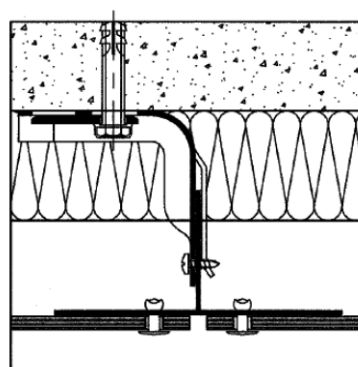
Buitenhoek (horizontale doorsnede)
